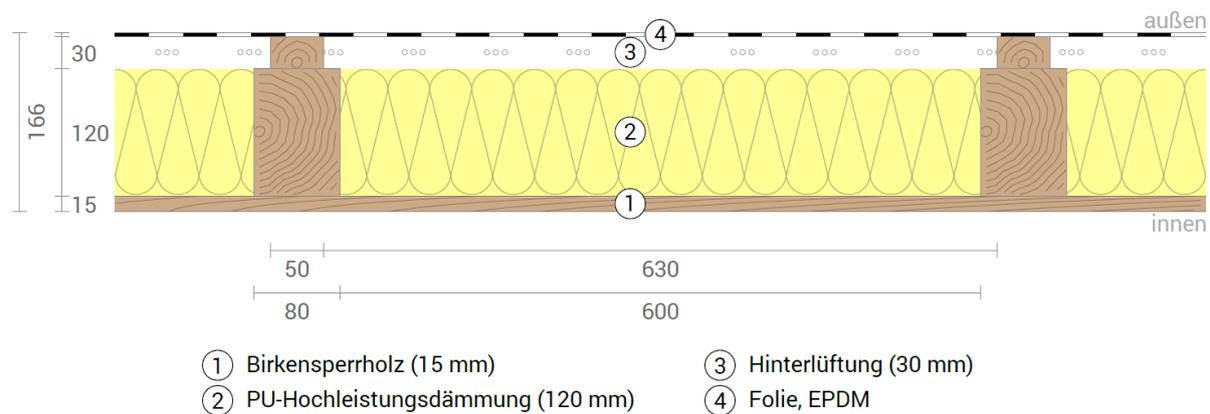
Materialisierung Aussenwand, «Anhänger» nach Tiny House Immergrün
